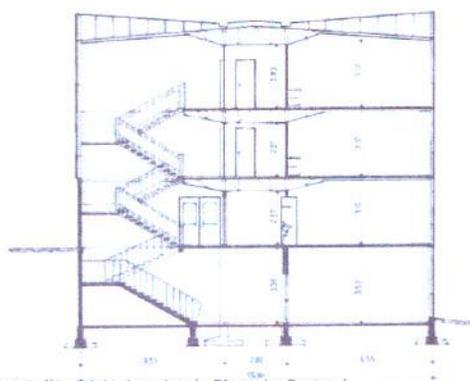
Collège à Hyères (arch. Pierre Le Breton)
